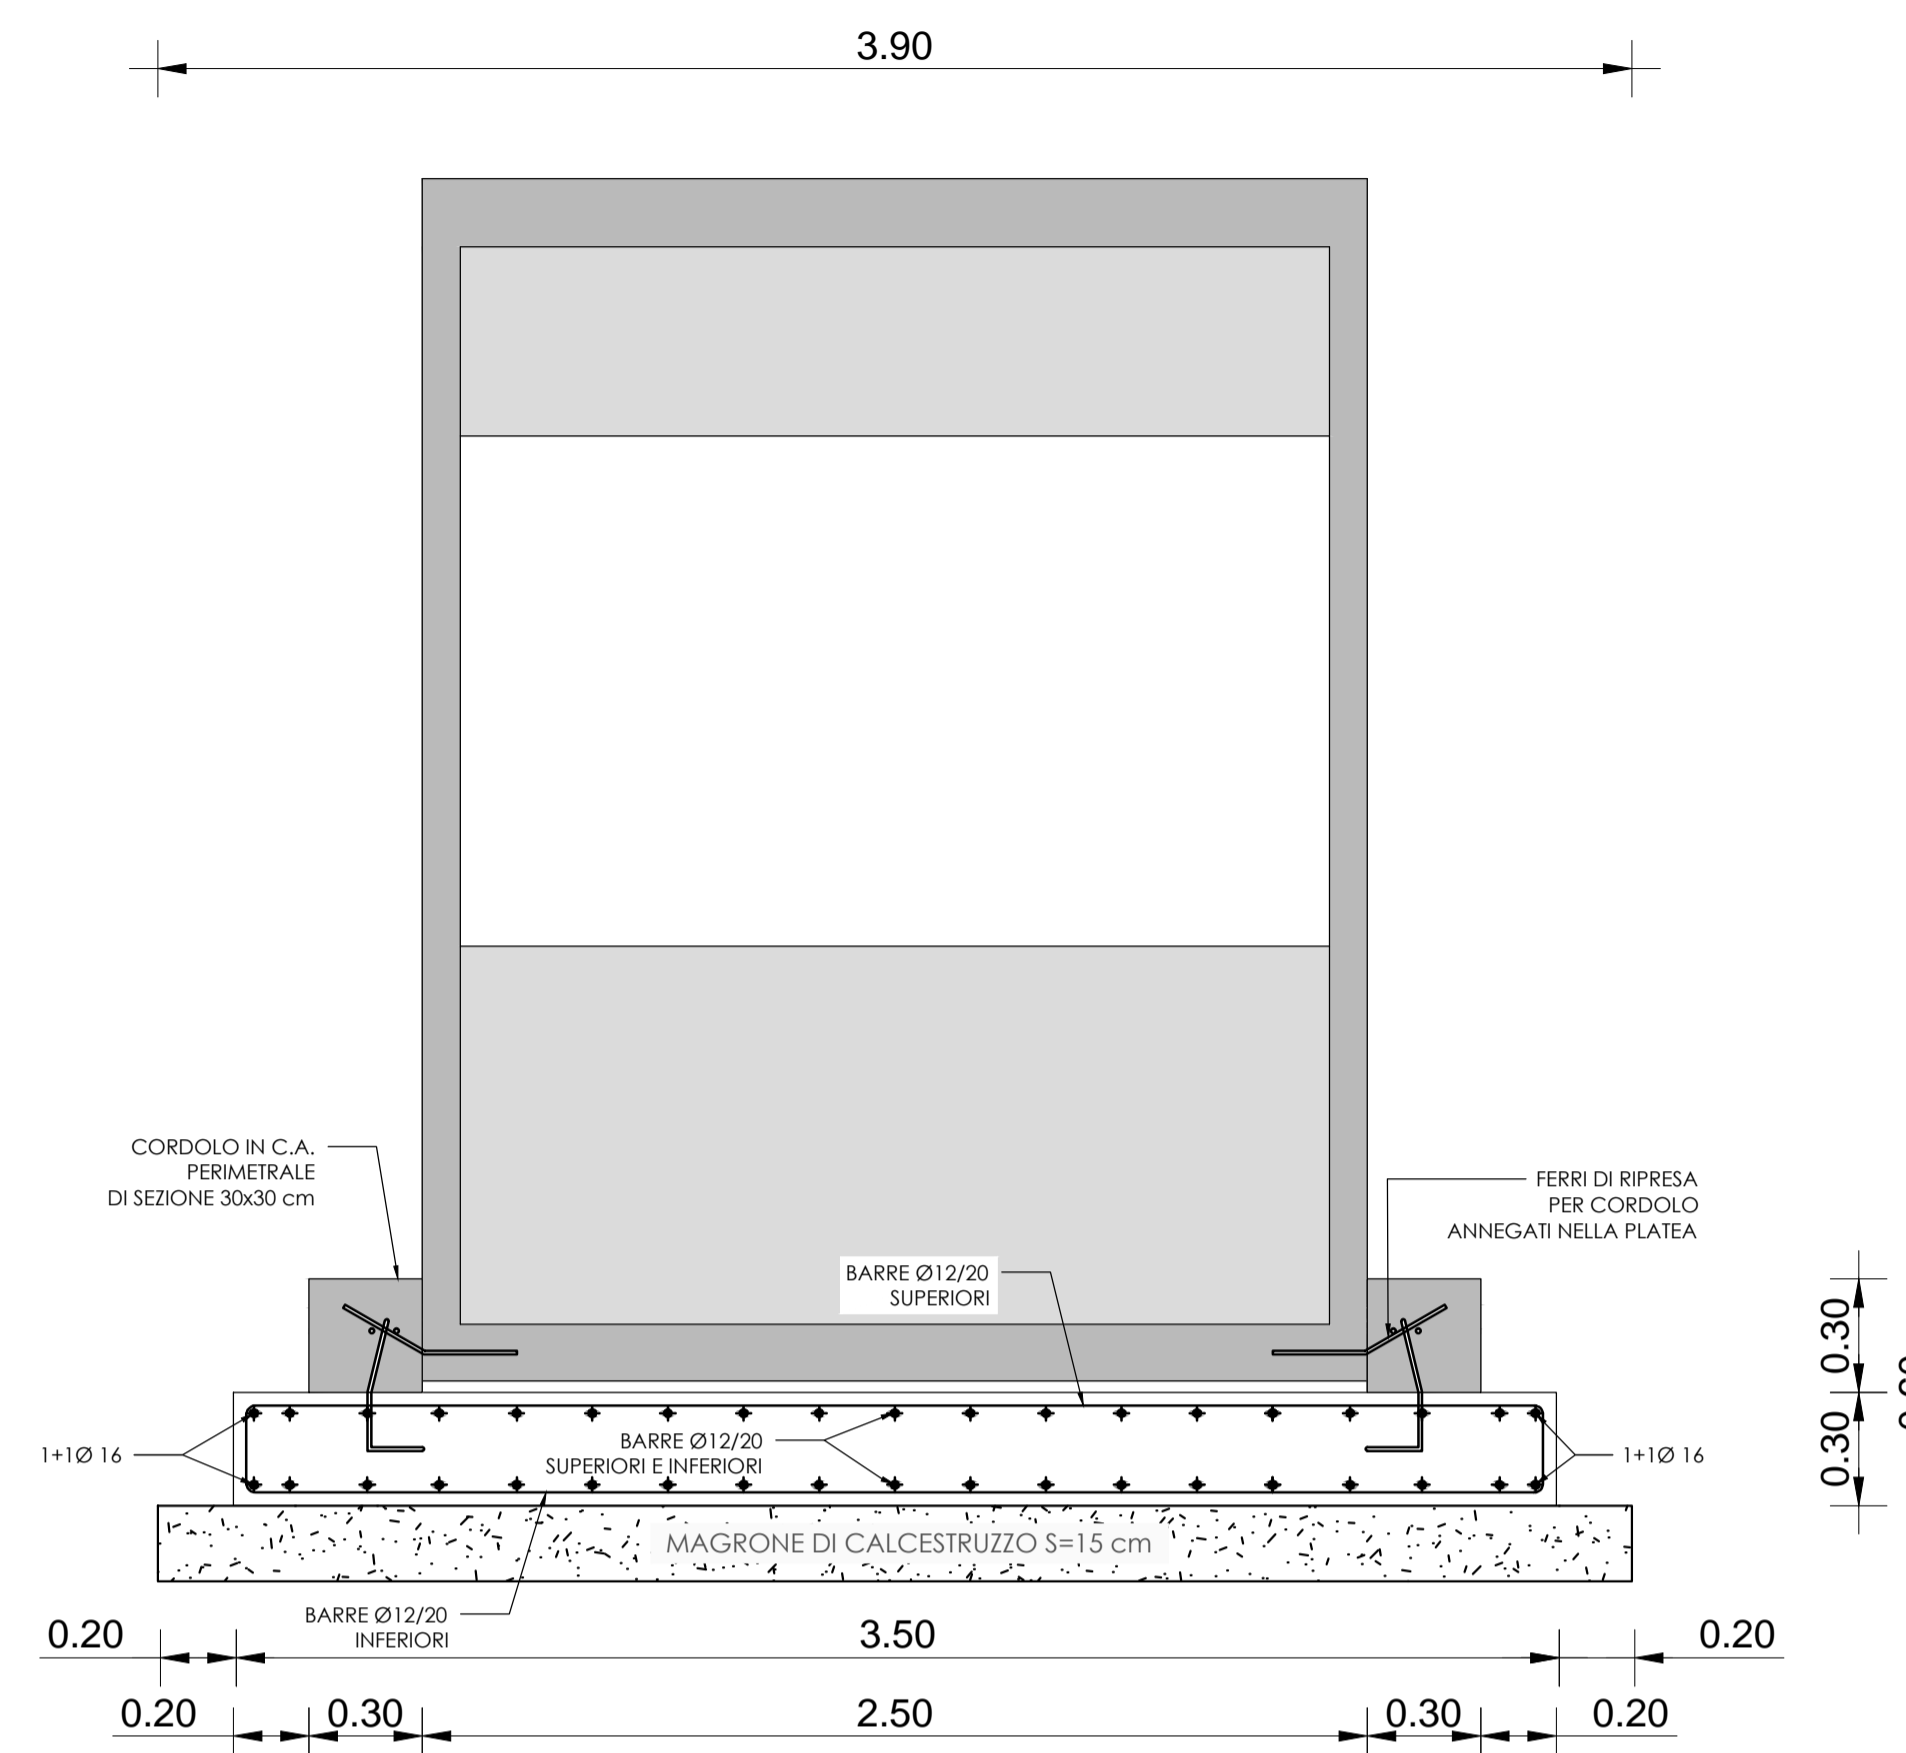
PLATEA DI FONDAZIONE IN C.A. DEL DISOLEATORE: SEZIONE A-A
